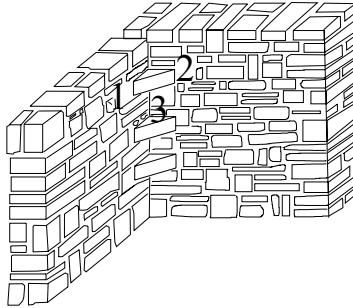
Duvardaki Hasarlı Kısımın Beton ya da Grout İle Doldurulması
